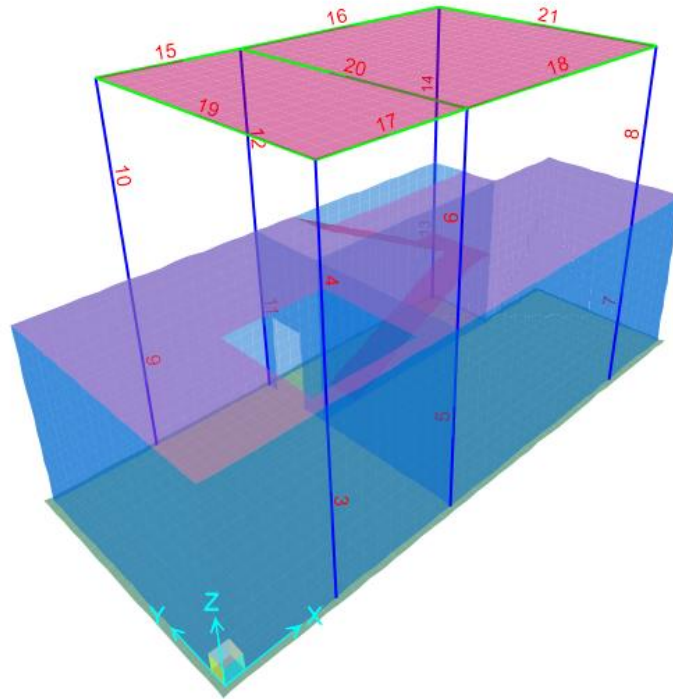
Vista assometrica modello struttura in elevazione - numerazione elementi frame
